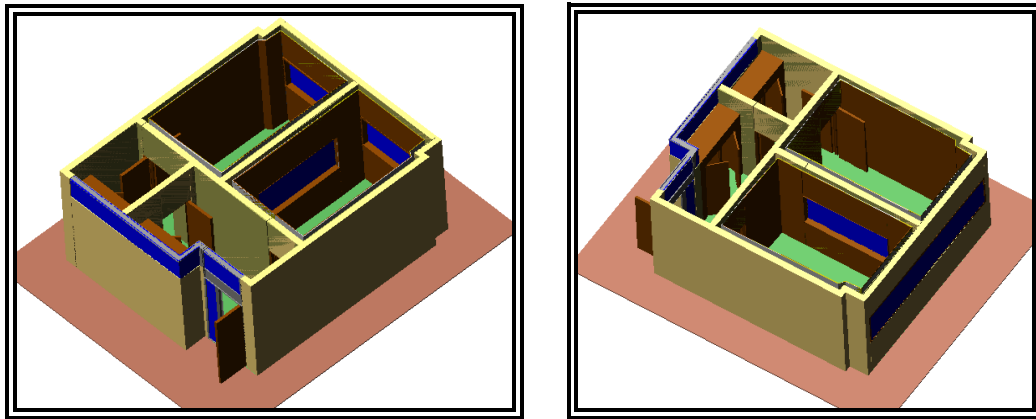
Propuesta del diseño del recinto “ver planos de la propuesta en anexos, cortes y detalles”
